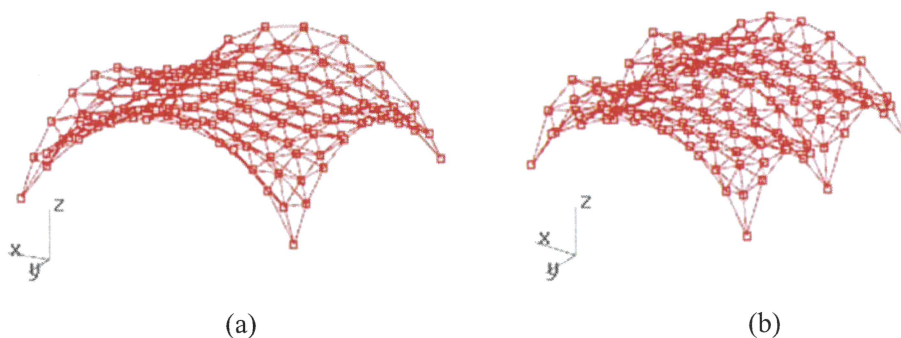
Analizowane konstrukcje prętowe z czterema punktami podparcia
